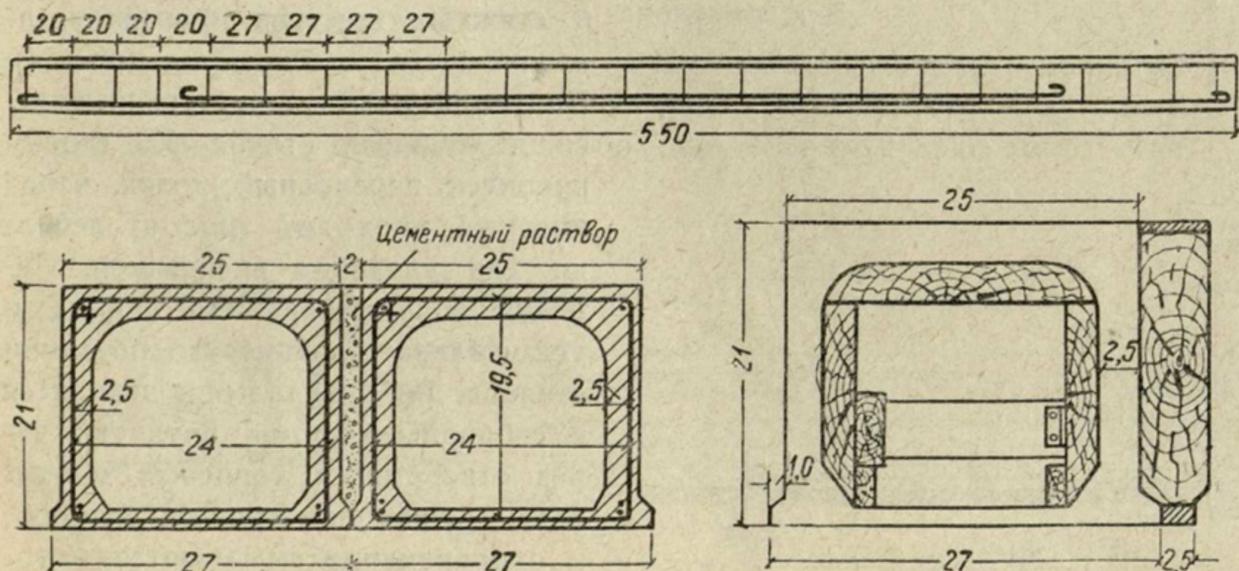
Балки Грубера. Схема армирования, формовки и укладки.
